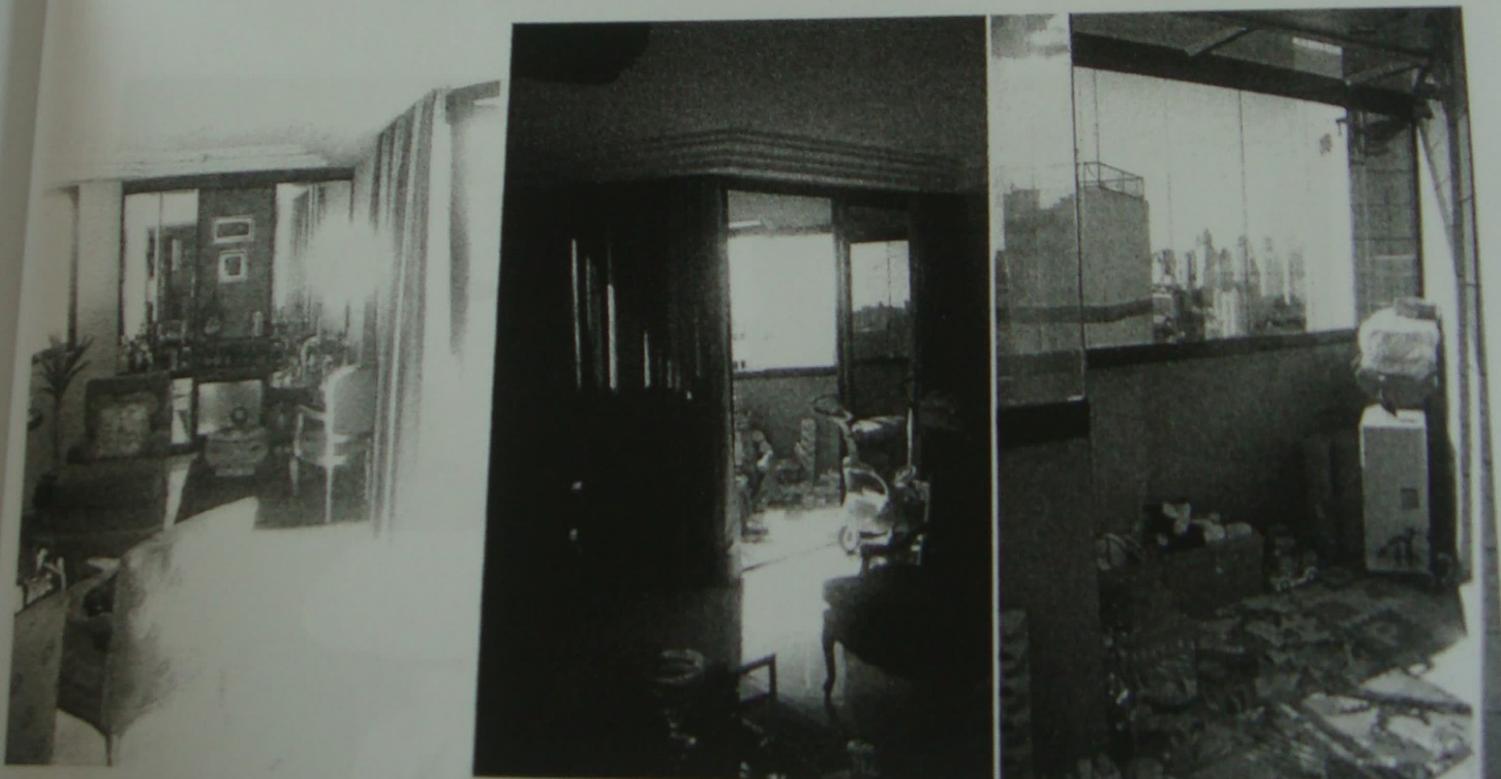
/21 - Vistas do hall de entrada e do lavabo.
